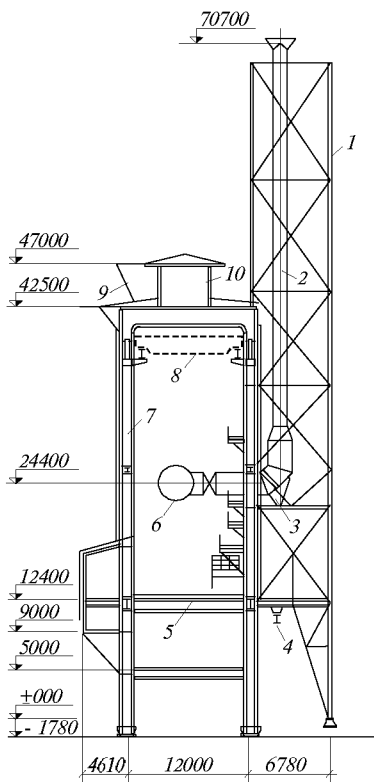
Поперечный разрез здания воздухонагревателей и трубопровод для постановки печи на тягу
